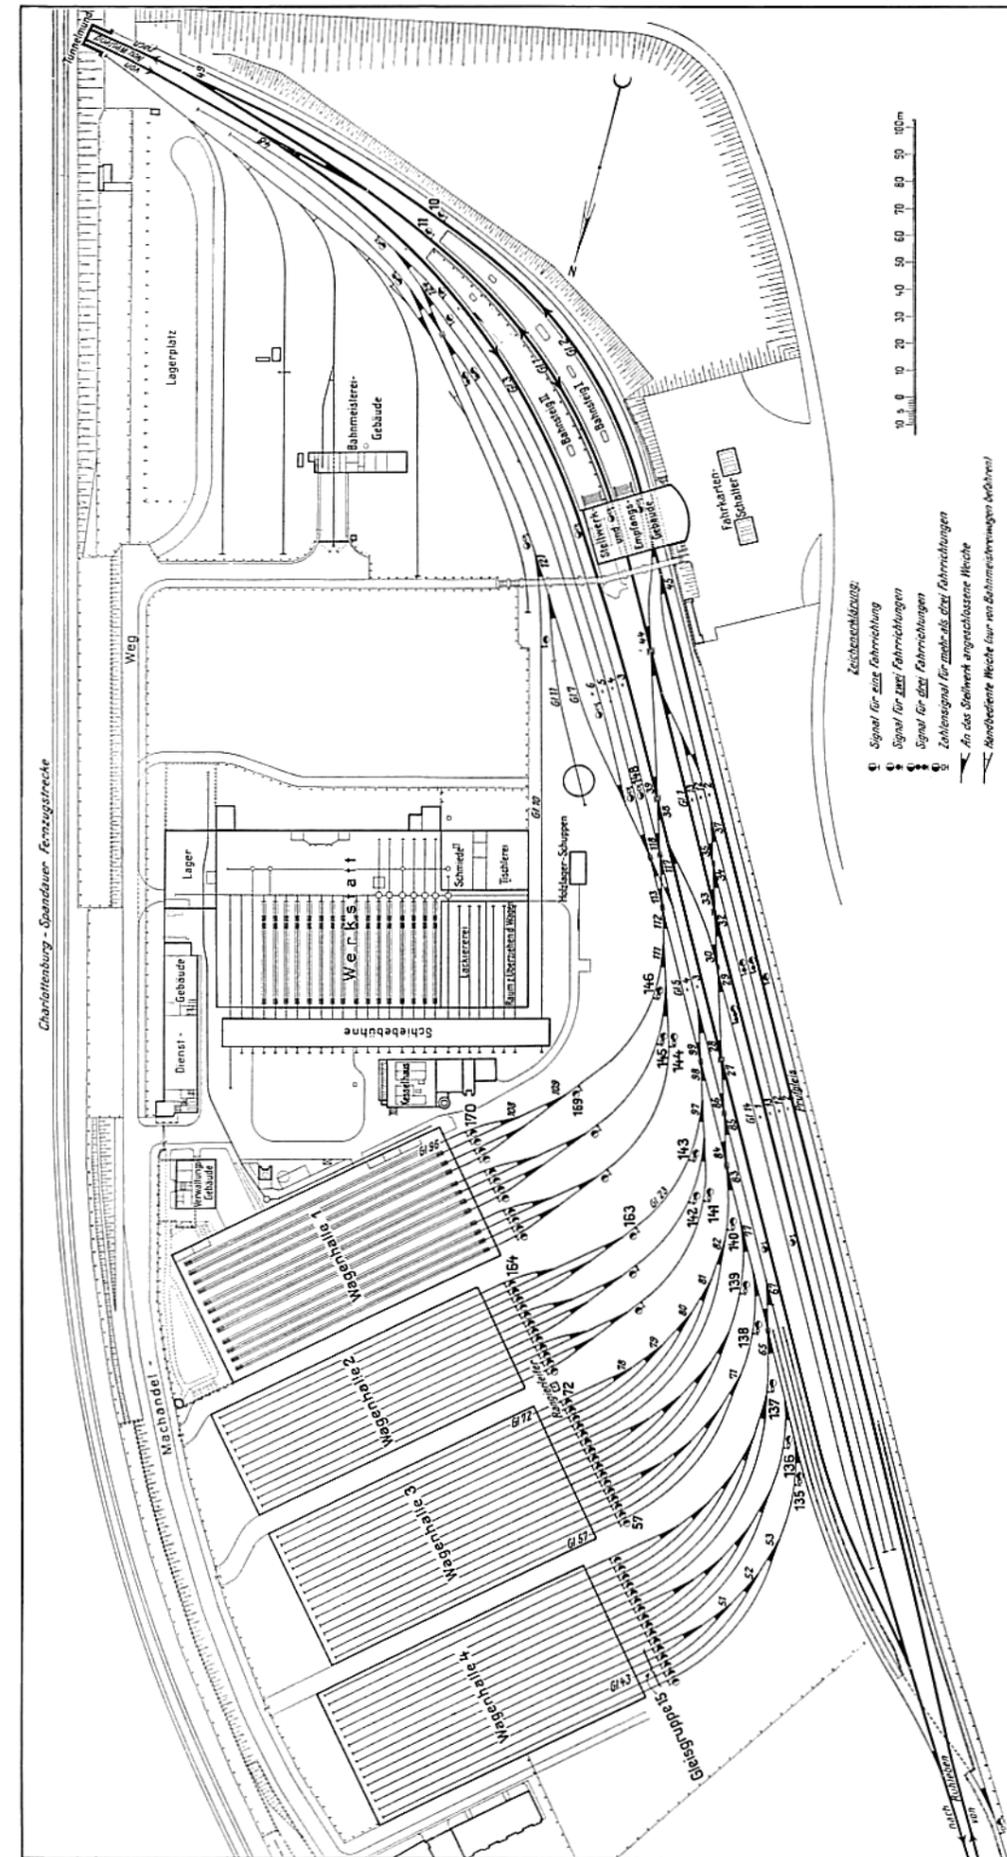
Betriebsbahnhof Grunewald, Lageplan.
